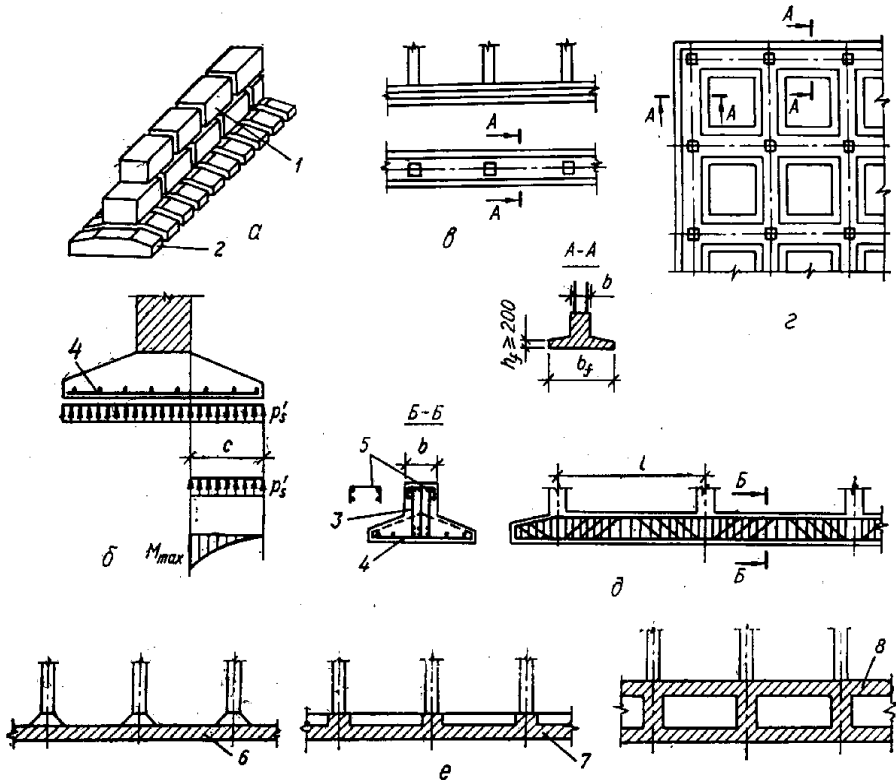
Стрічкові та суцільні фундаменти:
